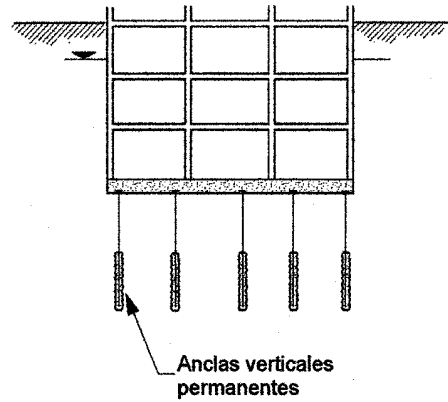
, Anclas en la cimentación de estructuras atirantadas
